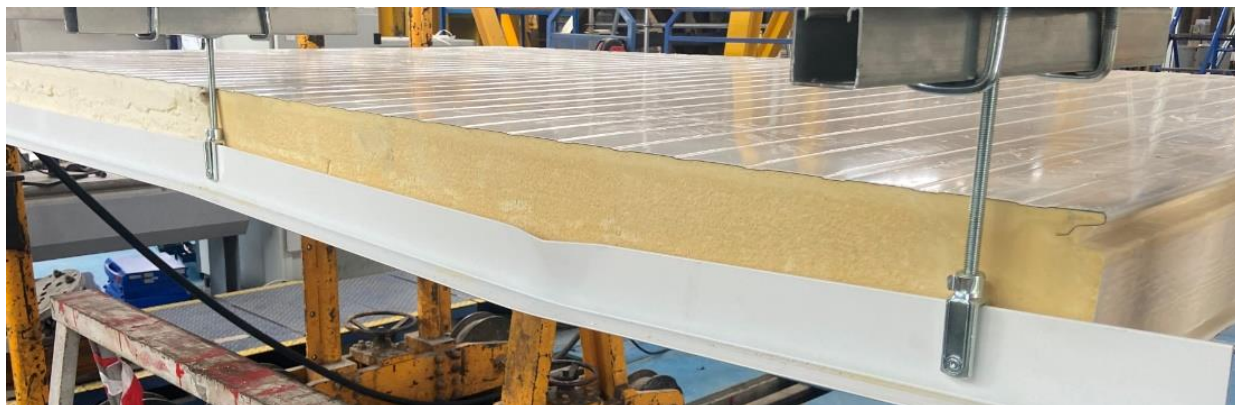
Fixation de levage centrale après essai (déformation au niveau de la suspente)
